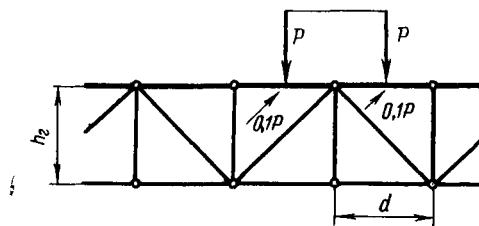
К определению изгибающего момента при расположении сосредоточенной силы P на панели верхнего пояса главной фермы
